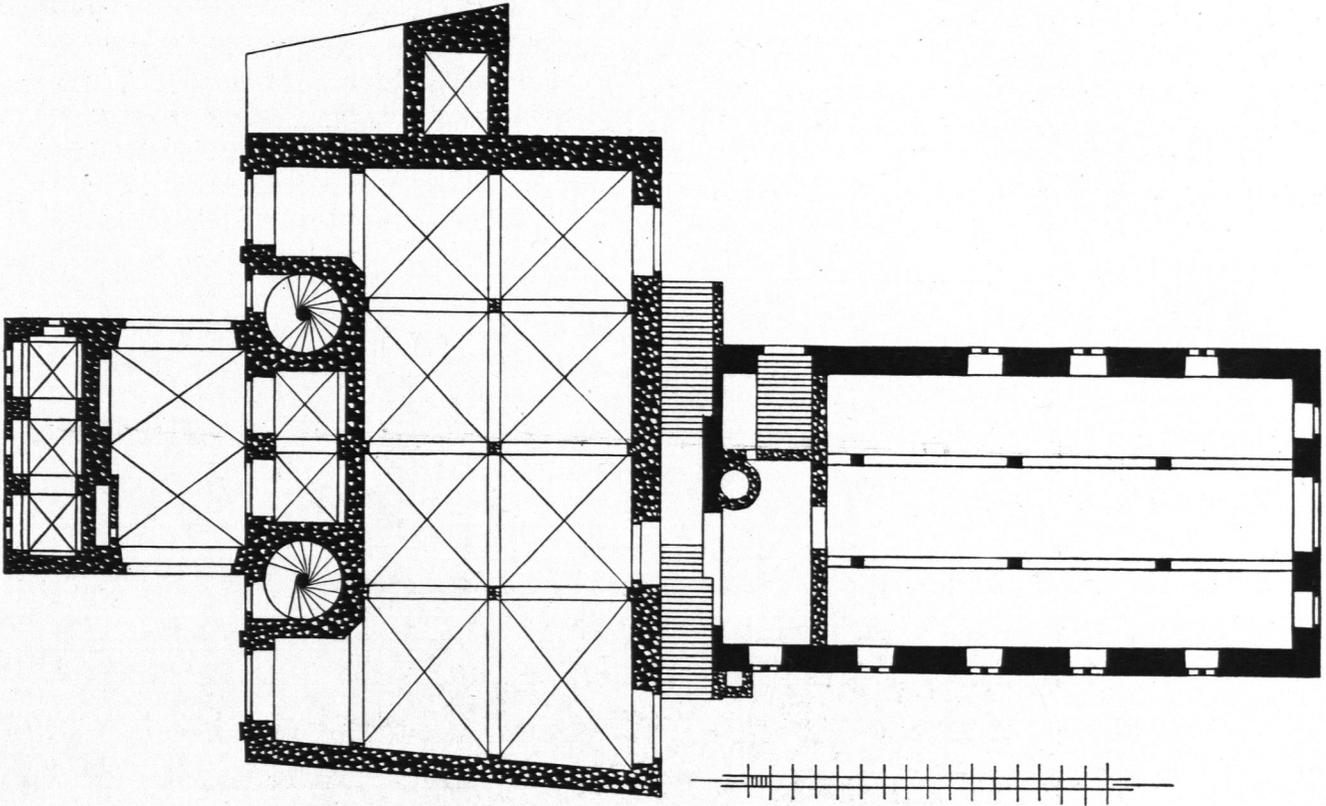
Rathaus zu Schweinfurt. Grundriß des Erdgeschosses.
